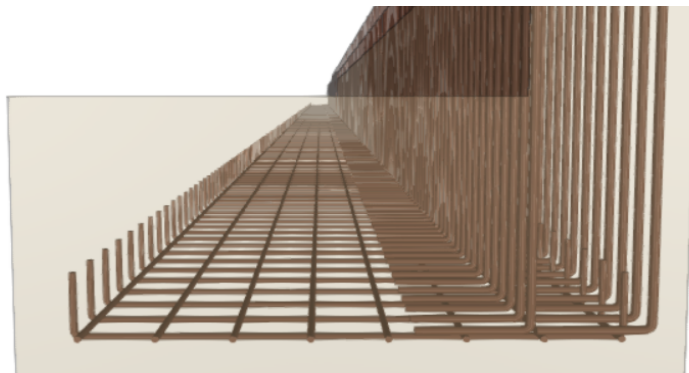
Armado de zapata de muros. Fuente CYPECAD
